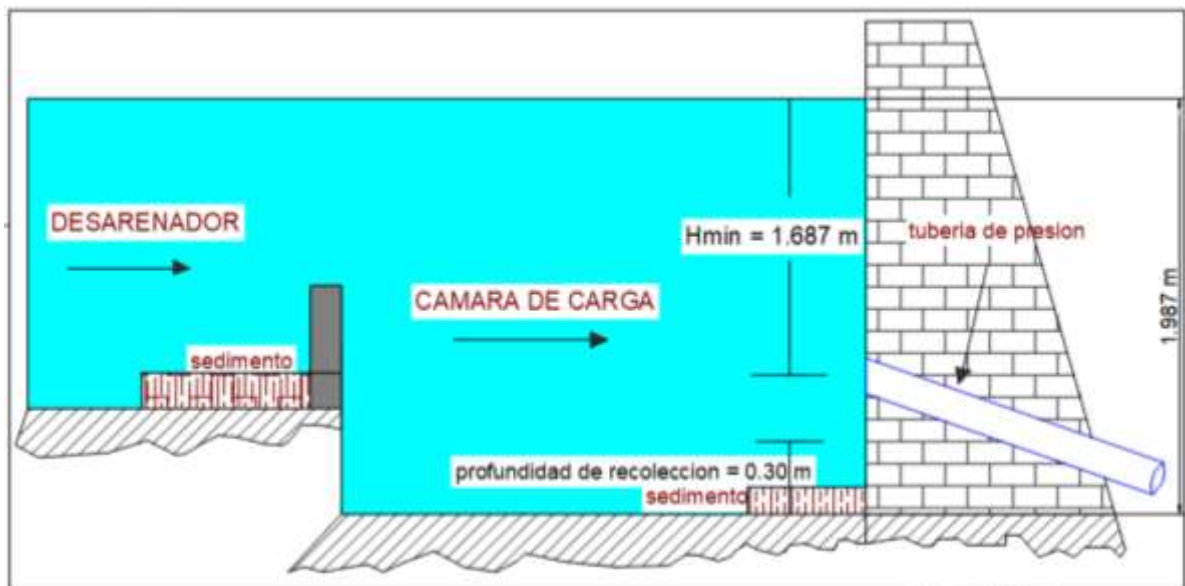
Vista de Planta del Desarenador y Cámara de Carga.
